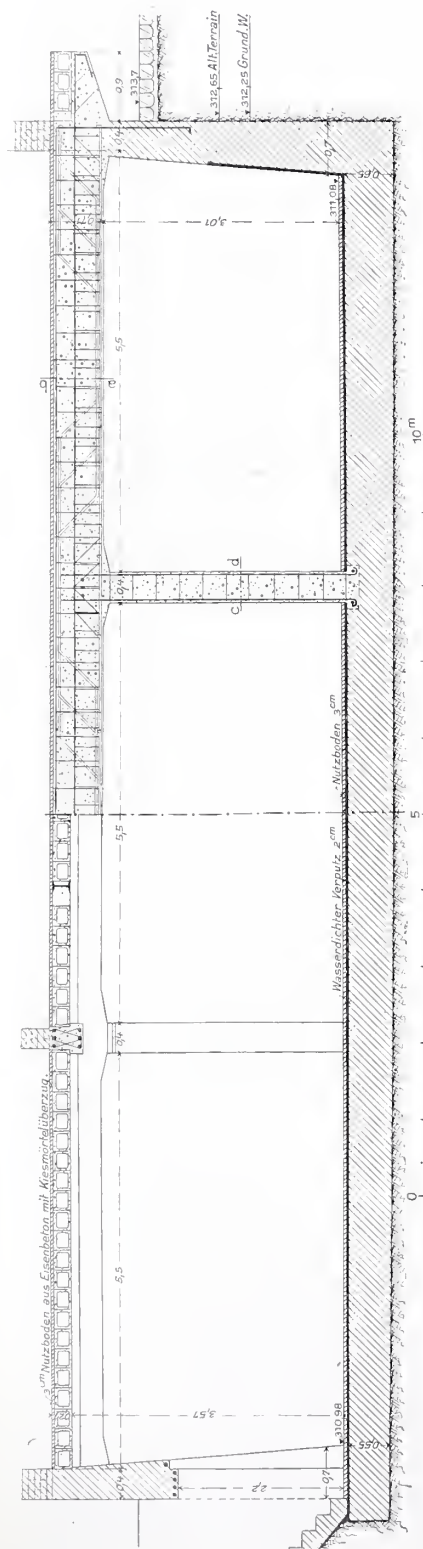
Längsschnitt nach a—b des Grundrisses.
